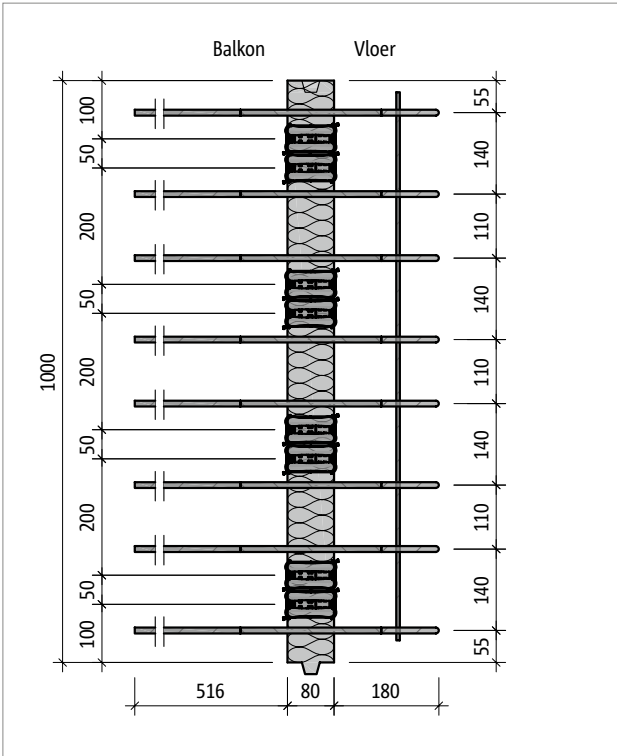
Schöck Isokorf® T type Q-E-V5: Zijaanzicht
